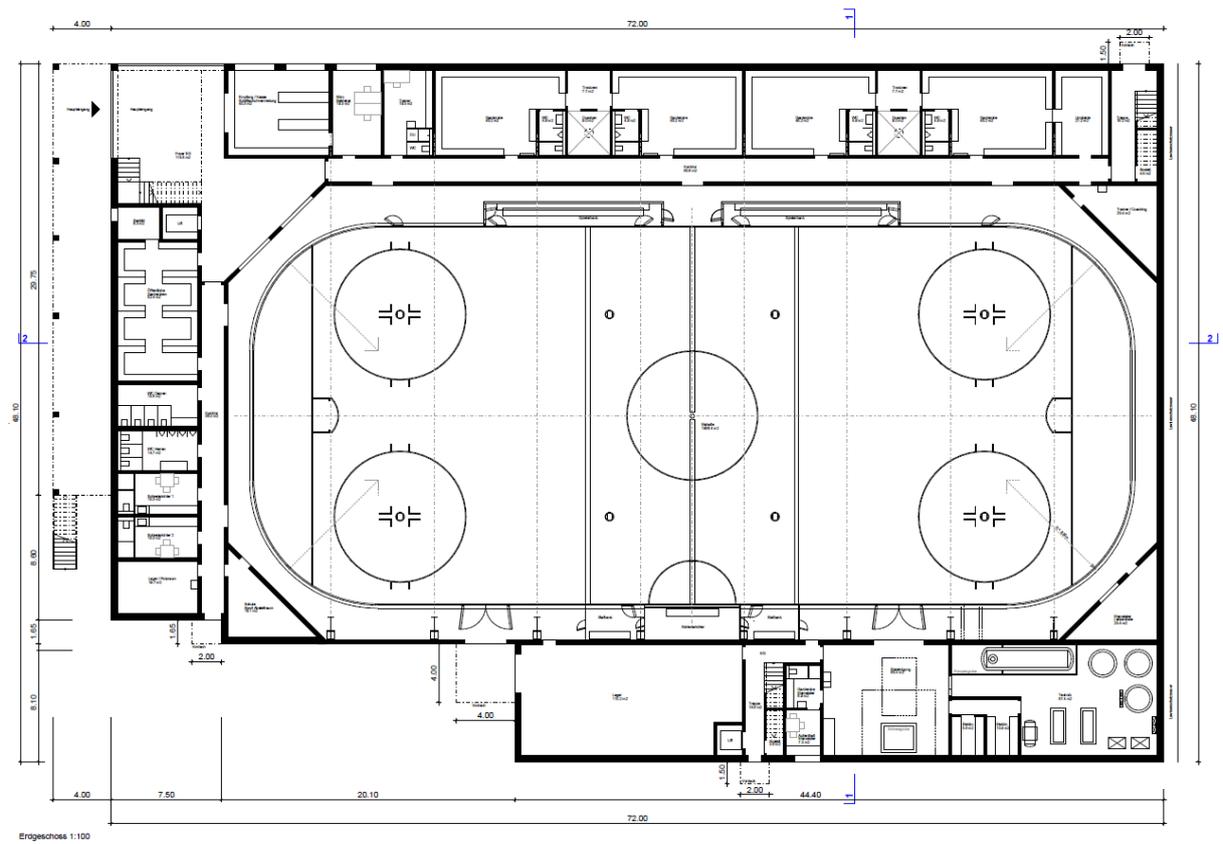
Grundriss Erdgeschoss (Quelle: Ricci Architekten, Brig).
